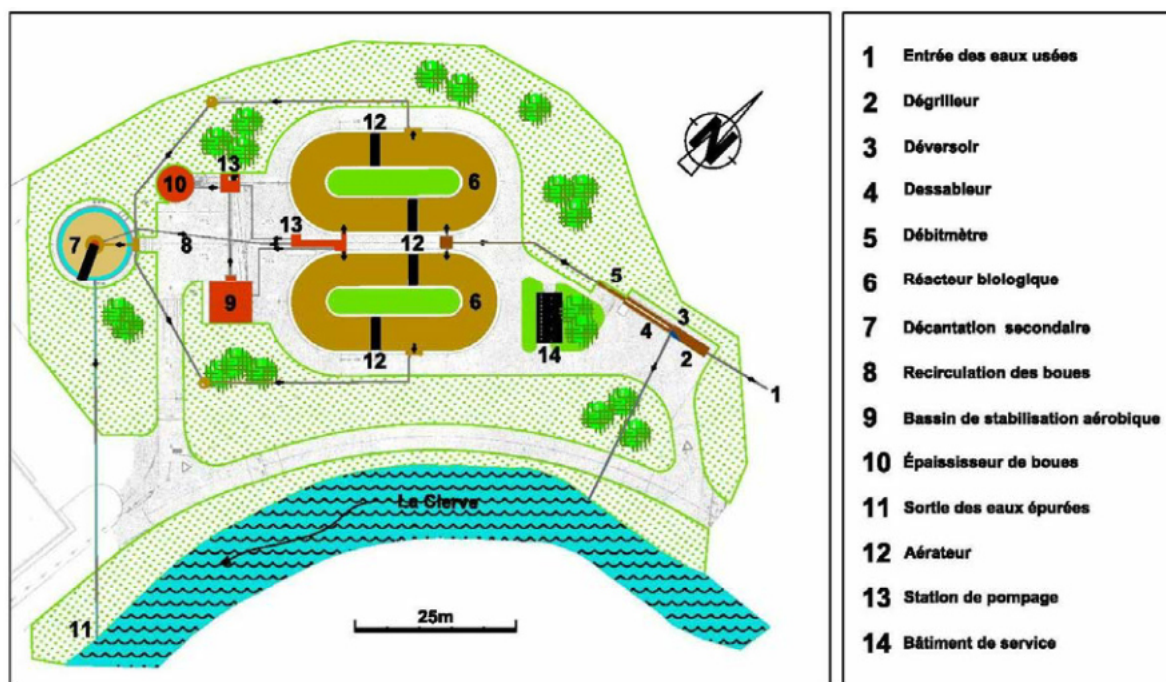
Lageplan und Anlagenteile der bestehenden Kläranlage Clervaux
